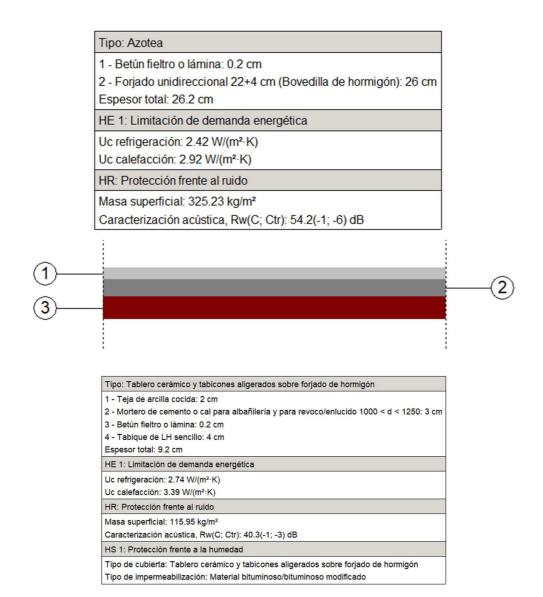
Detalle constructivo de cubierta inclinada ventilada. 45
